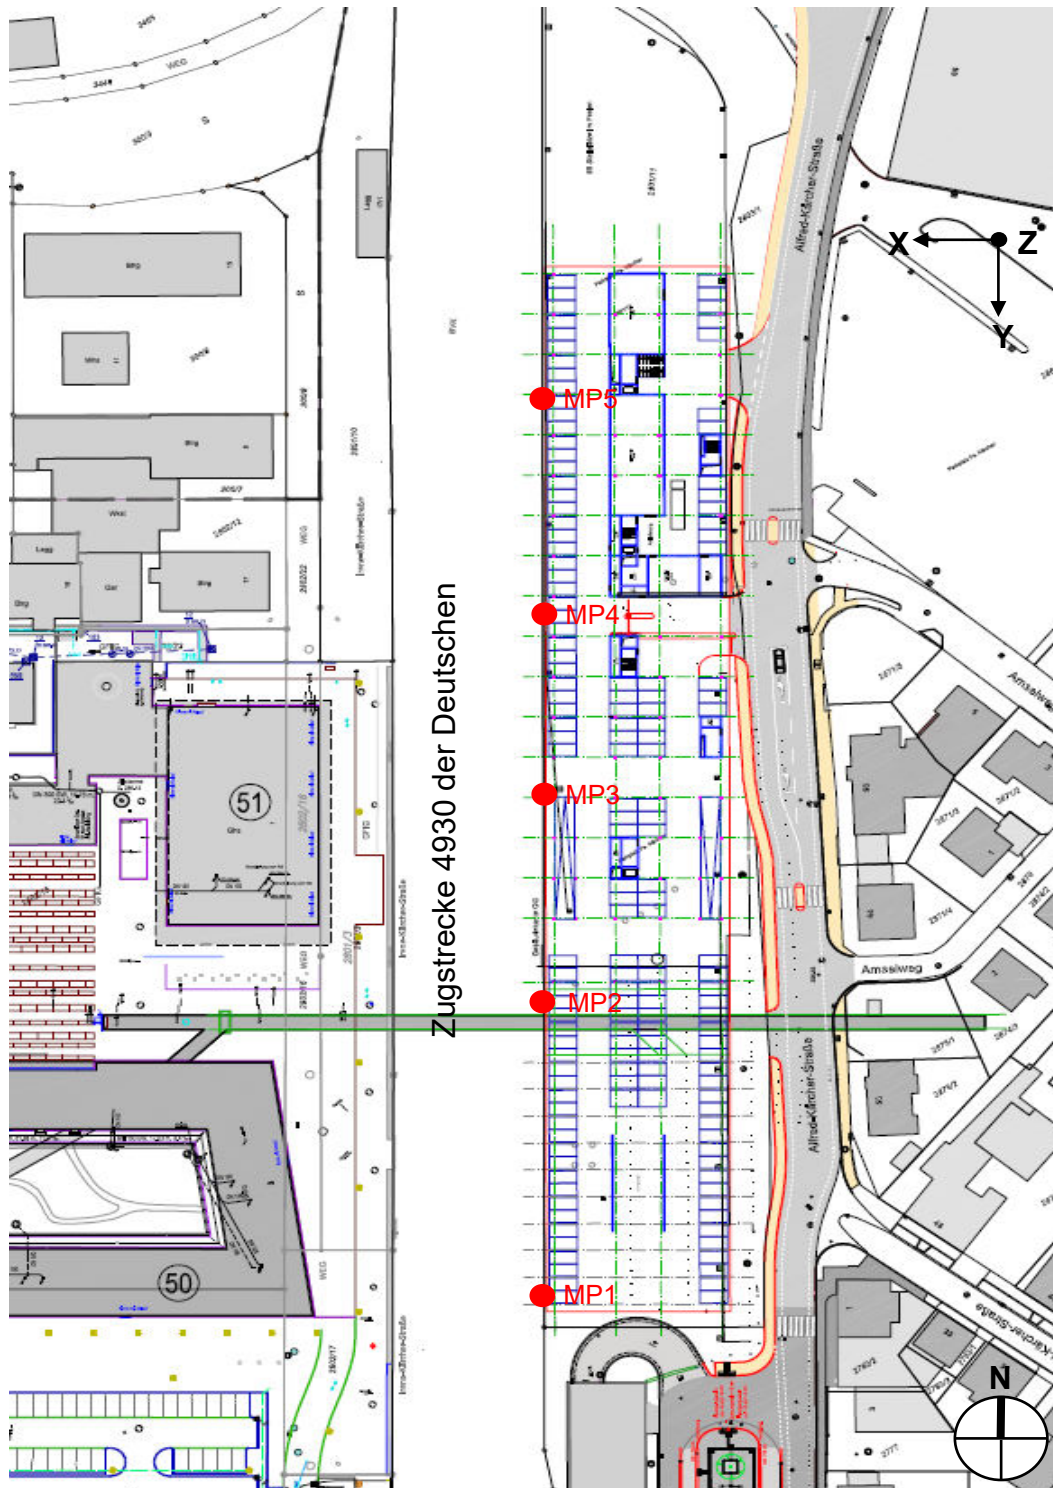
Lageplan mit Darstellung der Messpunkte und der Zugstrecke
